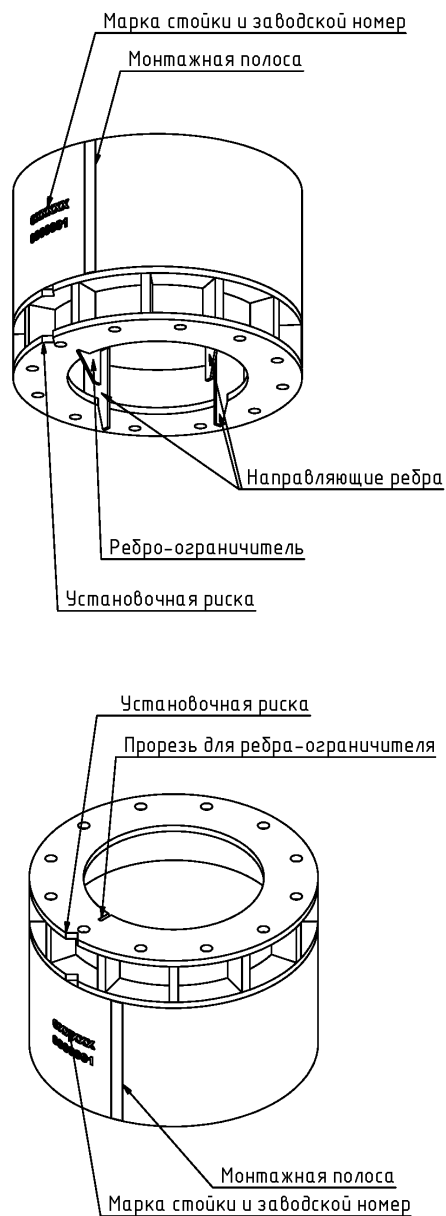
Закладные детали для монтажа нижней и верхней секций стойки
